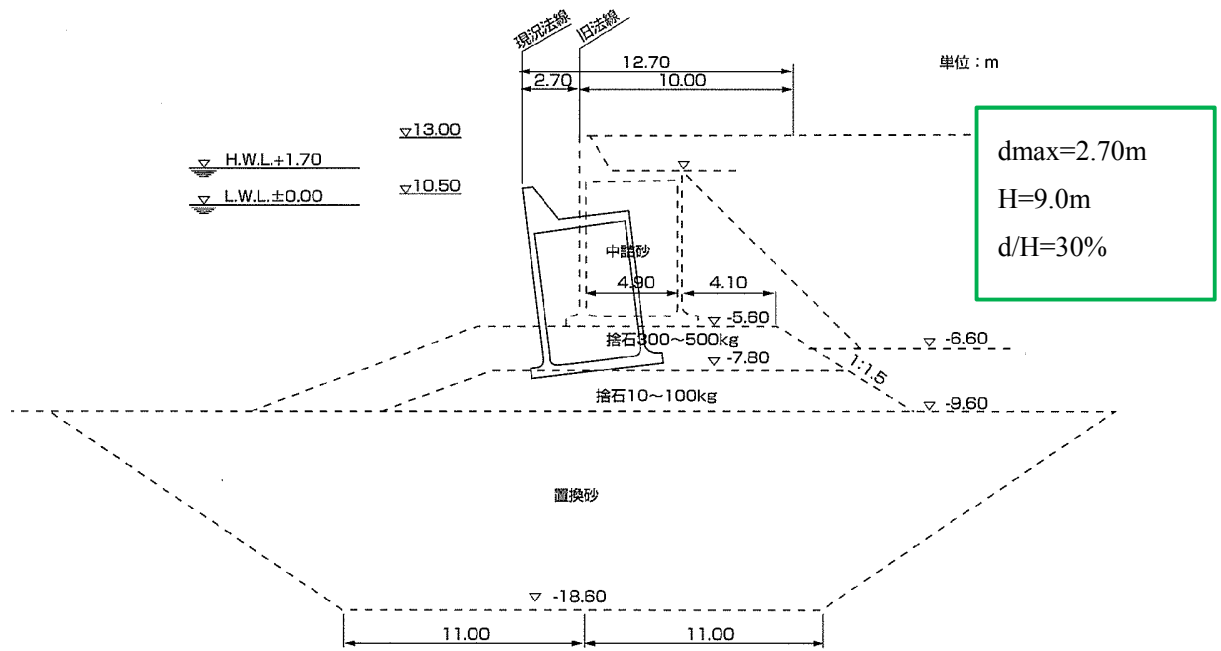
東部内貿埠頭-5.0m岸壁被災断面図 (施設番号④)
